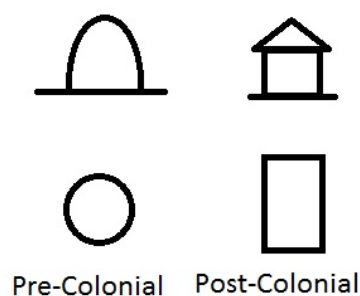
Planta y elevación de las casas pre y post colonial Fuente: Autoría Propia
